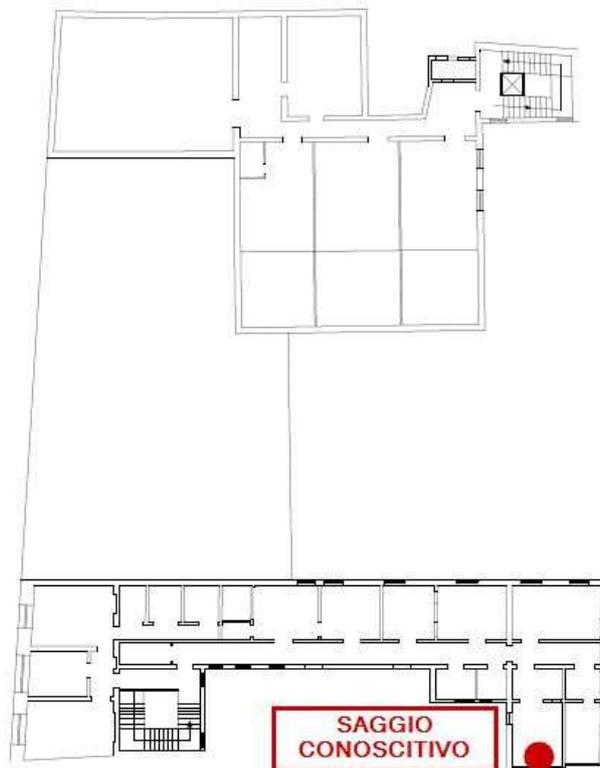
Estratto planimetria piano terra. In rosso i punti di prova
